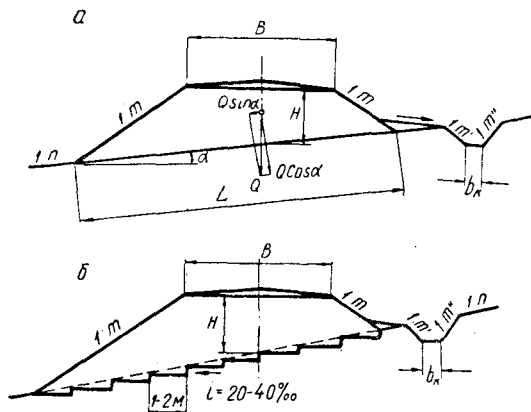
12. Расчетные схемы для определения устойчивости насыпи на косогоре
